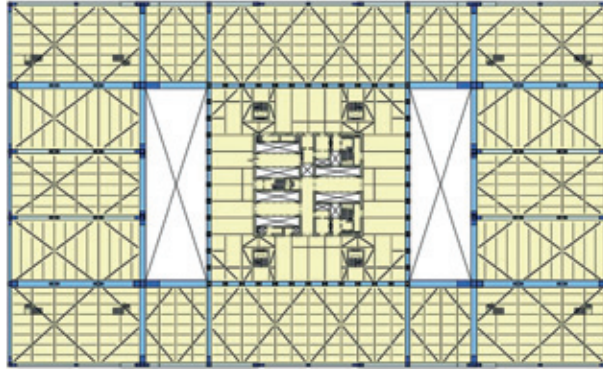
显示桁架布置(蓝色)的裙楼标准层平面图
